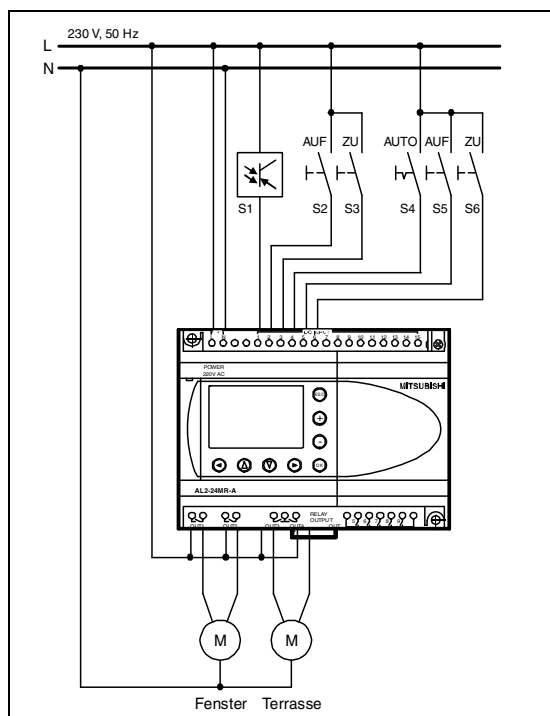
Beschaltung der Steuerung für die Rollladensteuerung
